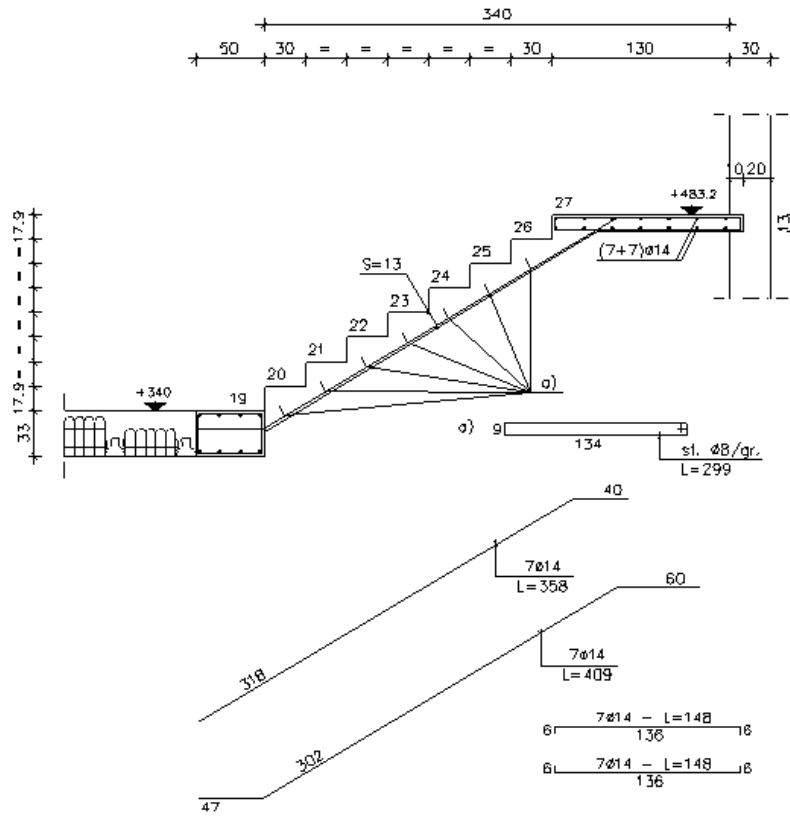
Ex-Lavanderie - stato di progetto: Sezione D-D
